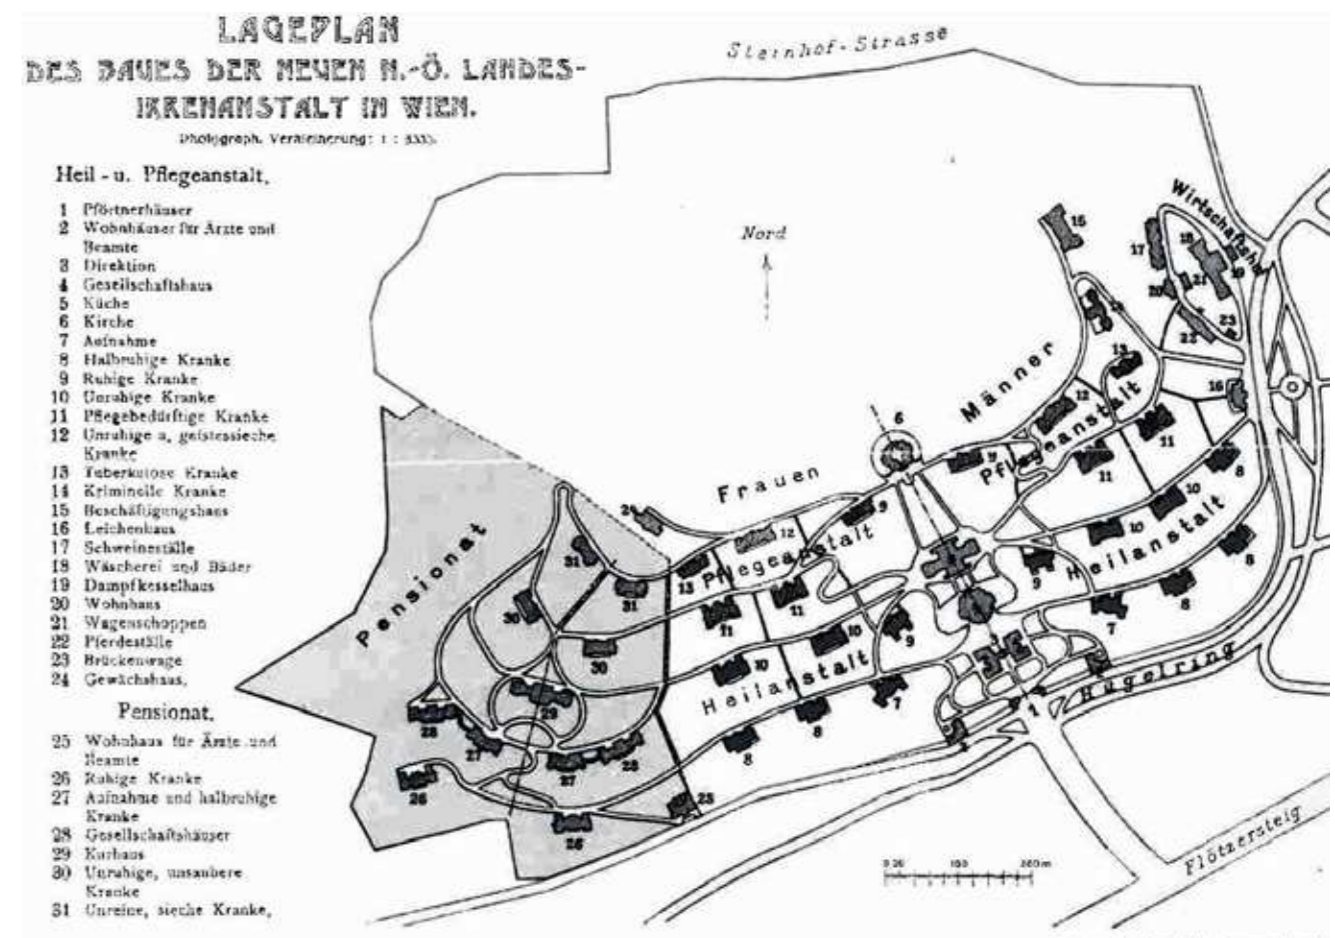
Carlo von Boog, Steinhof Lageplan 1902
